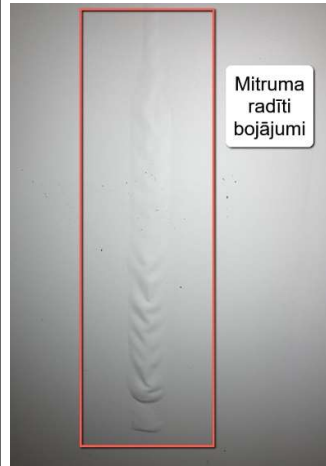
Foto Nr.129.	Foto Nr.130.
